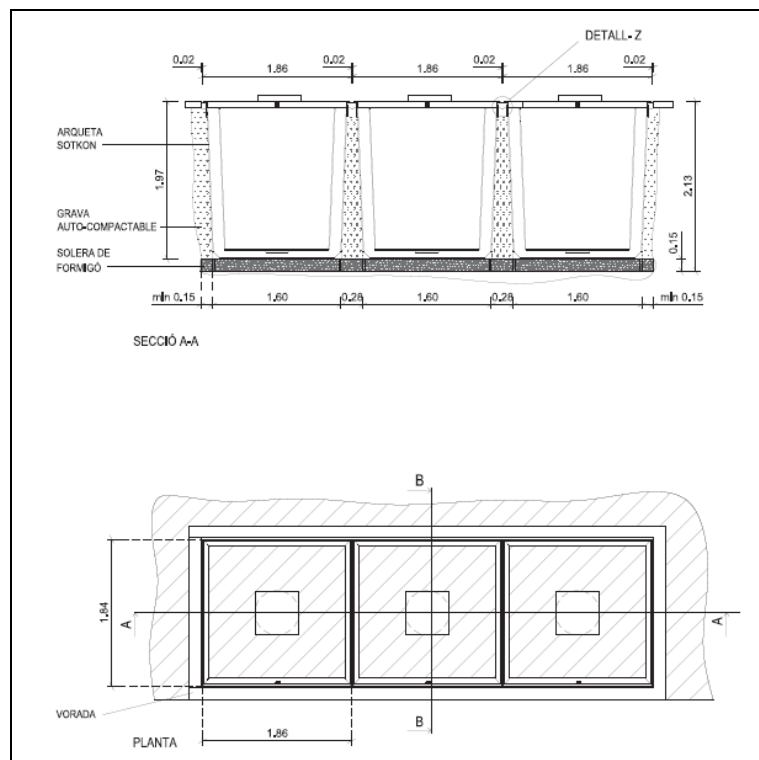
Planta i secció de les caixes de formigó dels contenidors soterrats.
